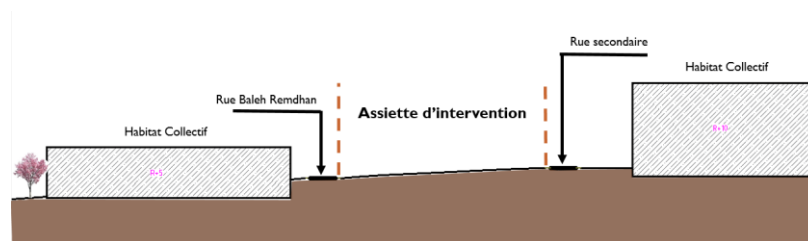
Coupe AA sur l'assiette d'intervention.
